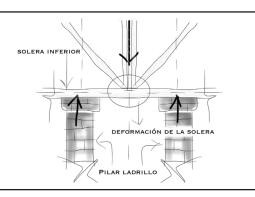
VIGA-CIMIENTO-FRACASO PILAR-VR1
